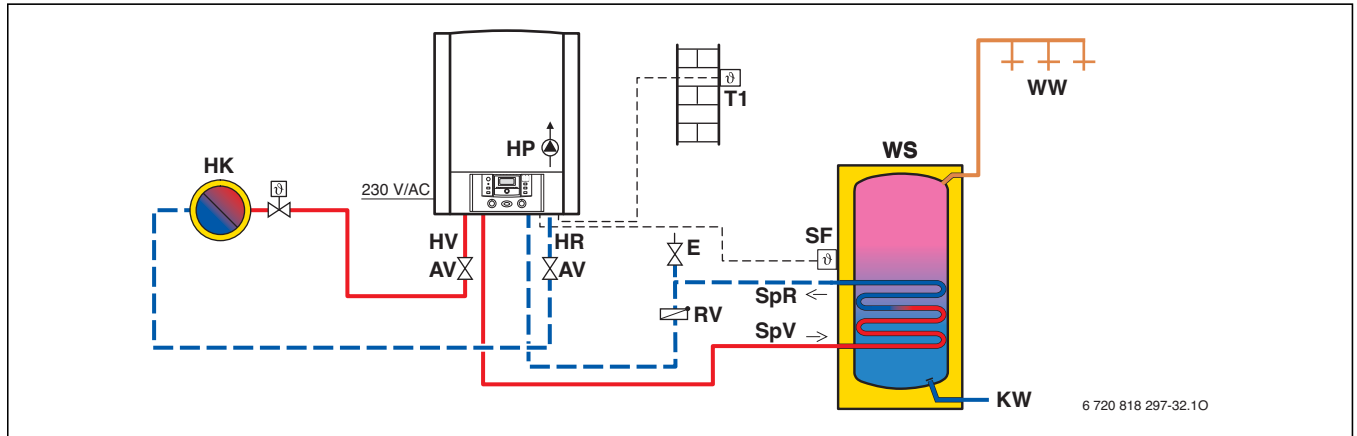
CerapurAero mit nebenstehendem Warmwasserspeicher
